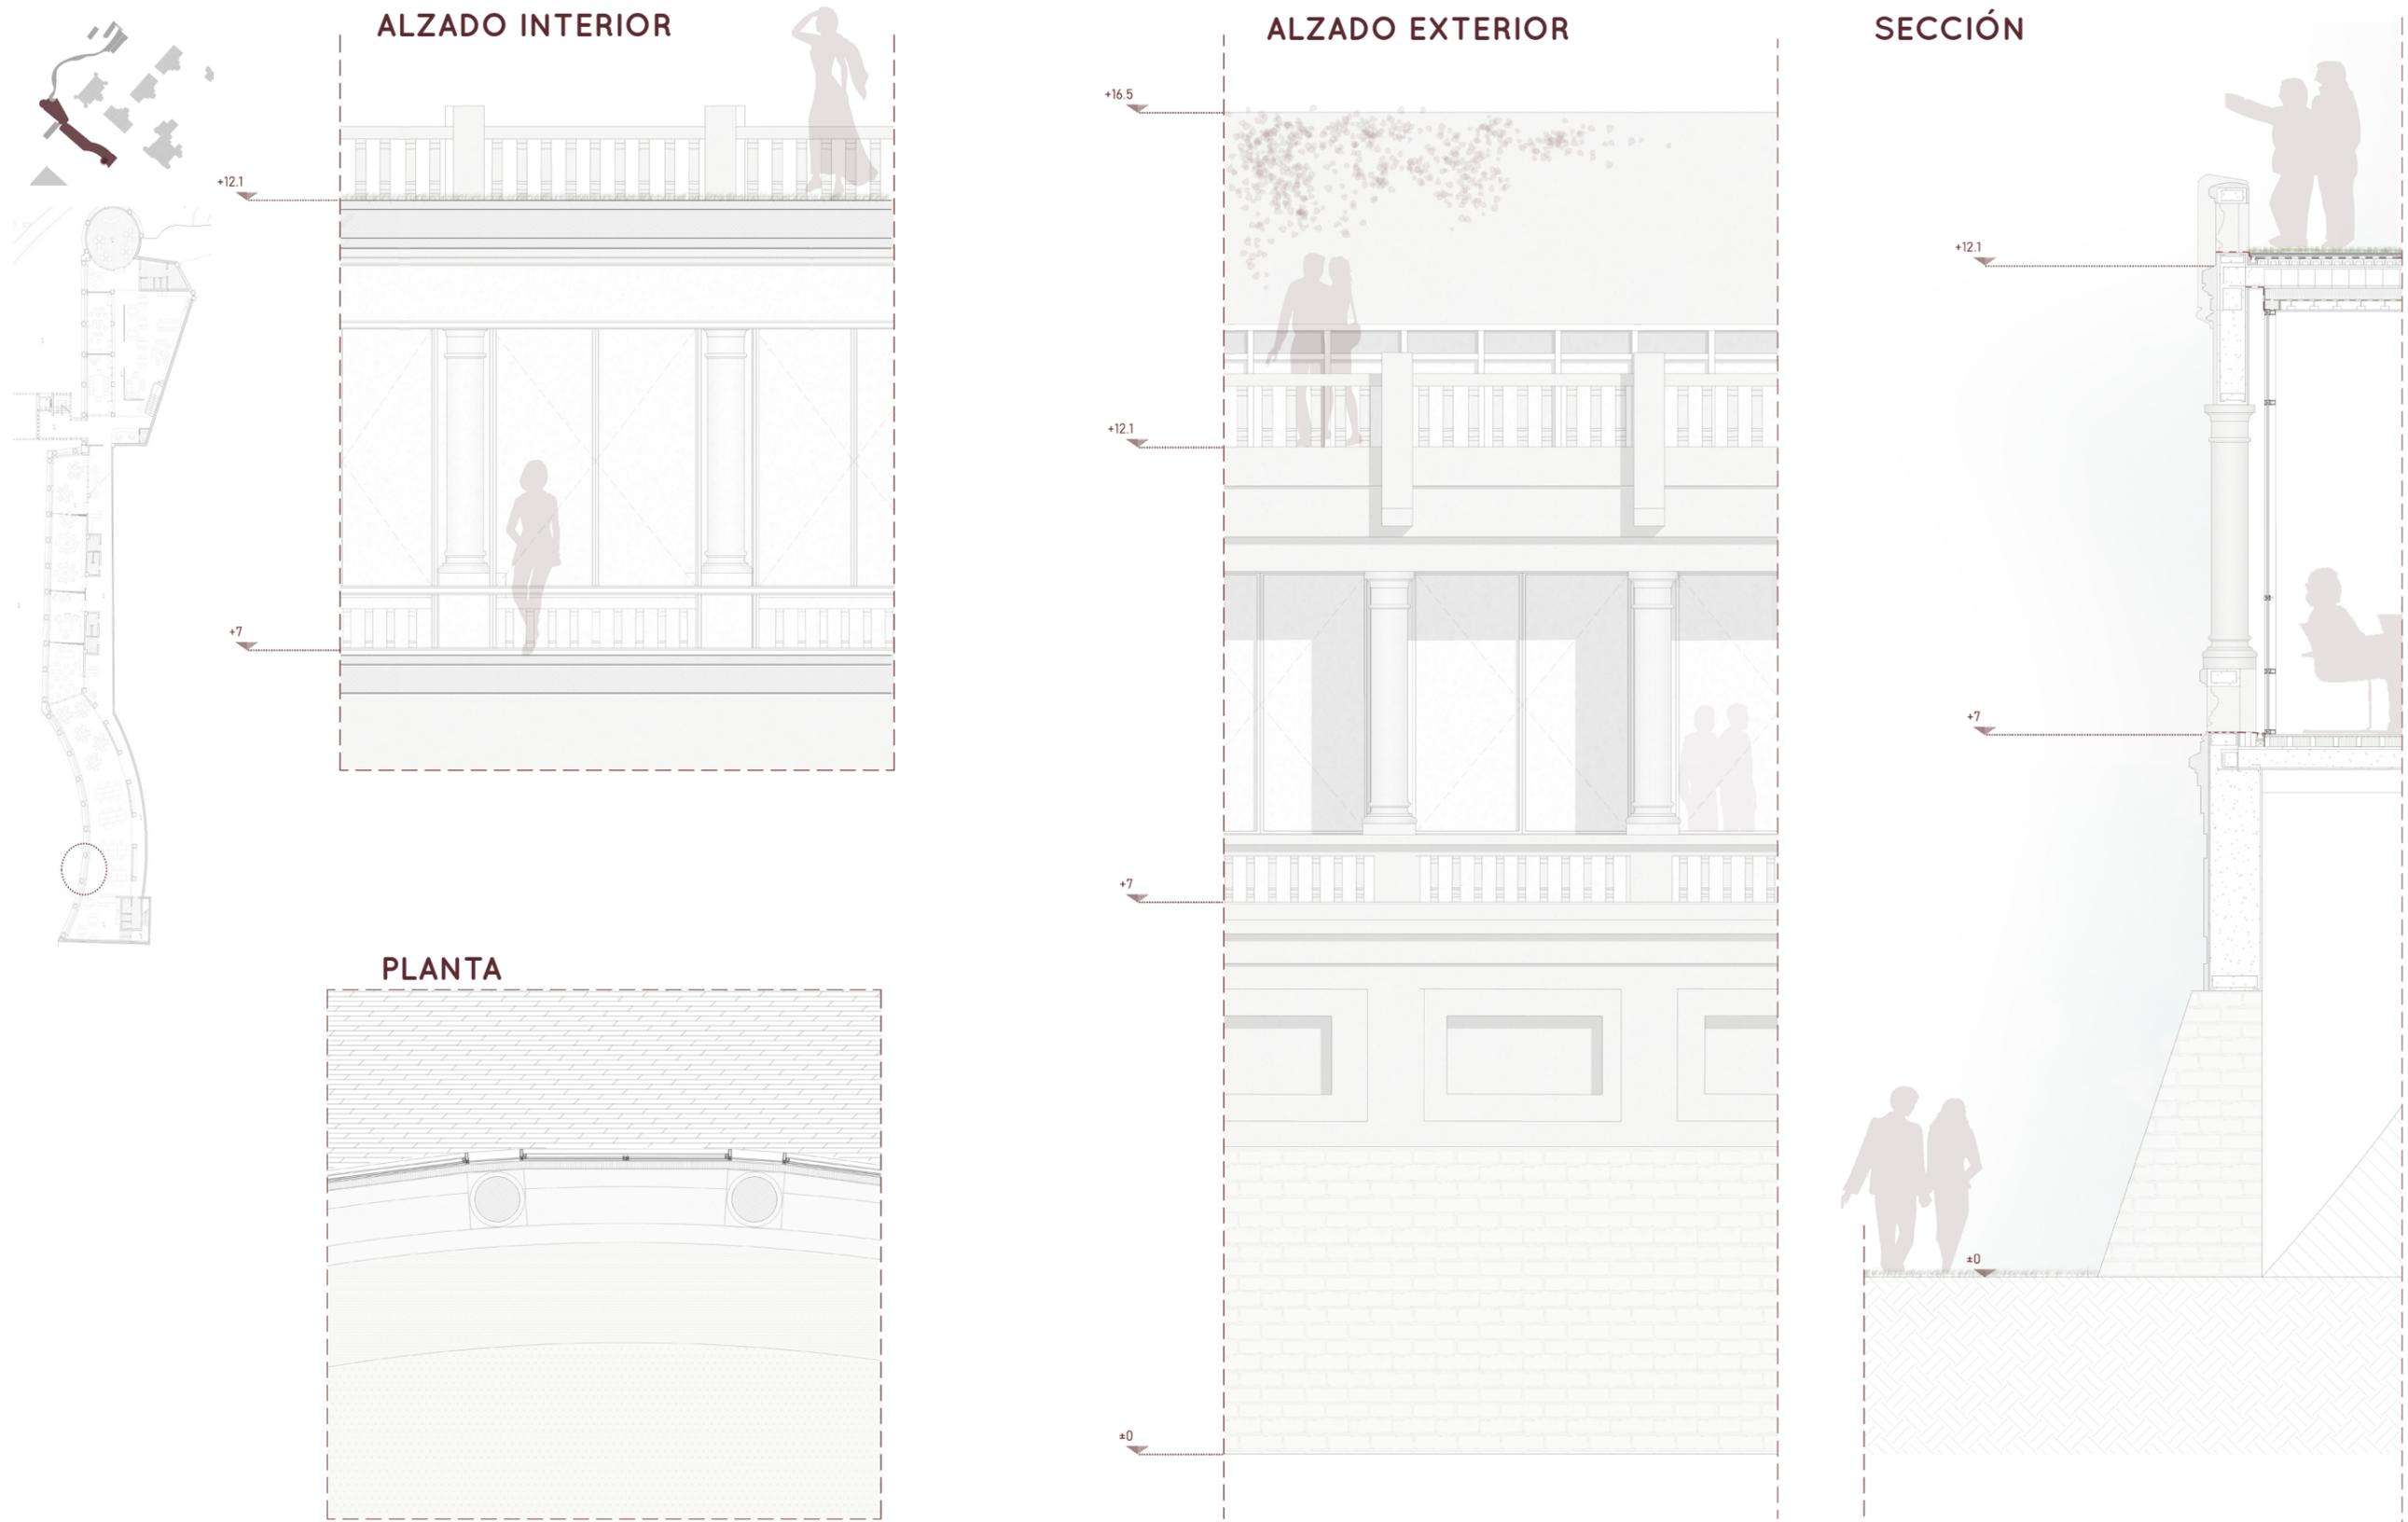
Detalle constructivo de la unión de la carpintería del nuevo cerramiento con la galería suroeste existente.
